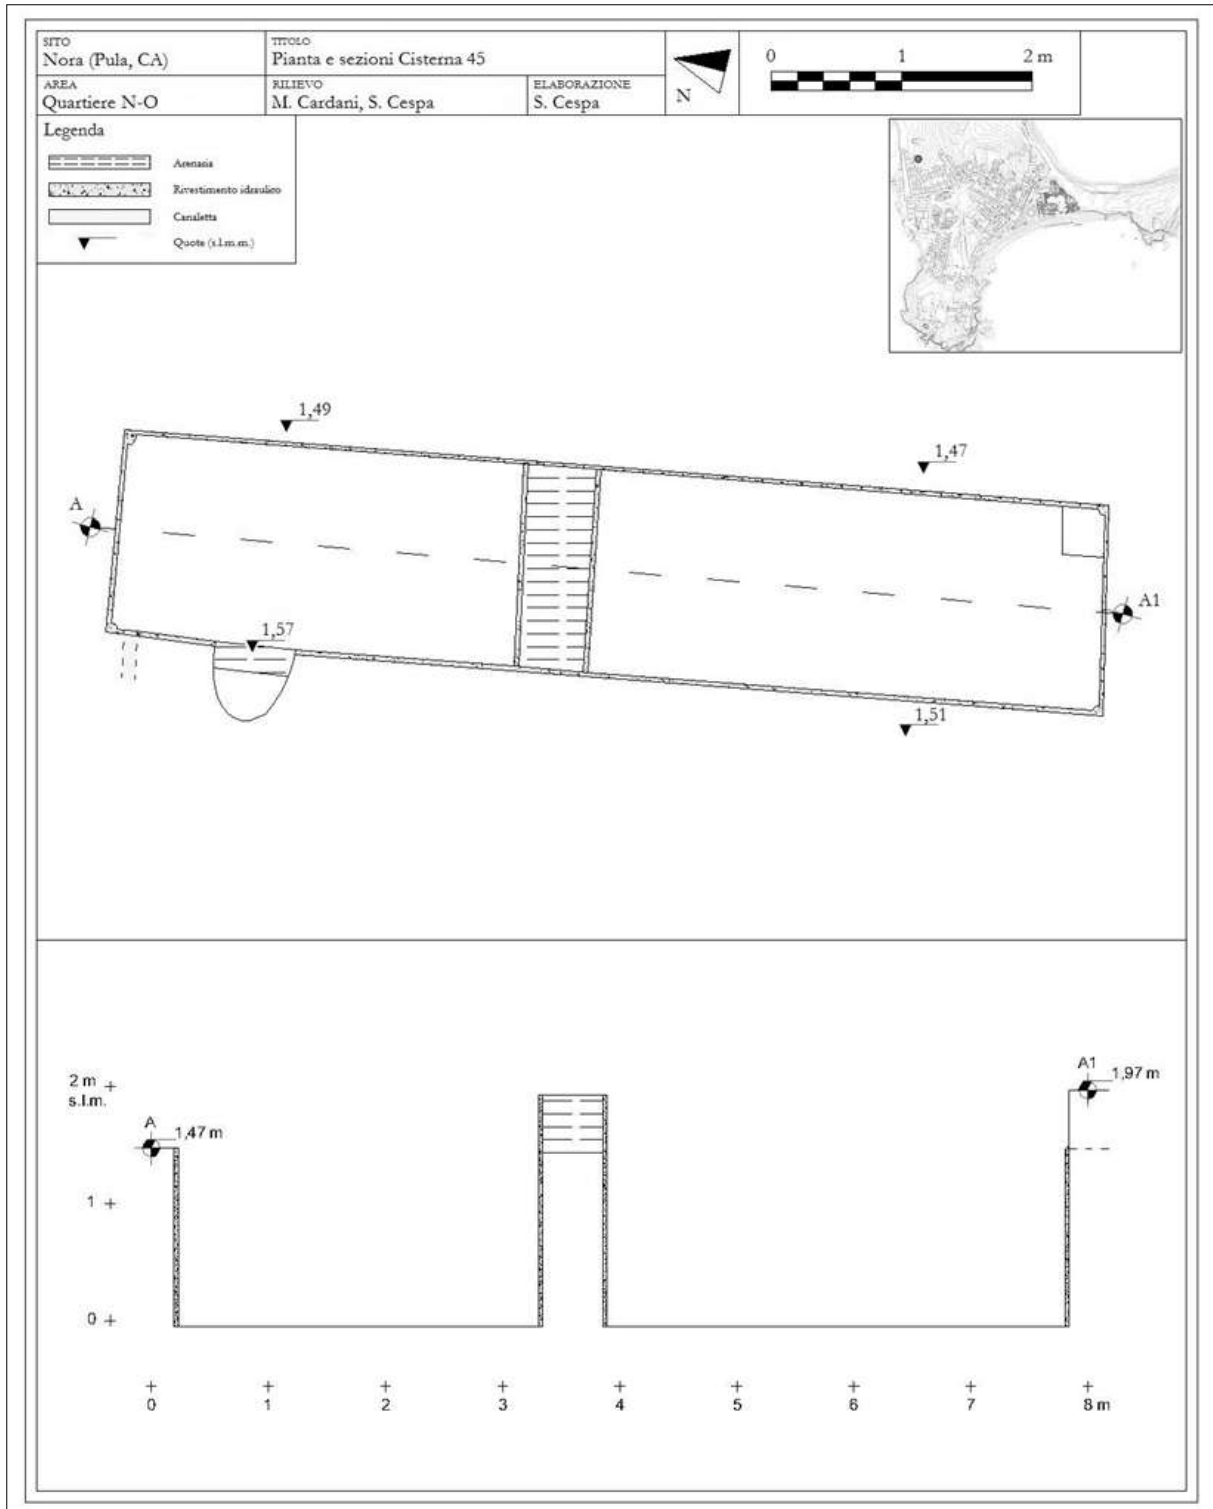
Pianta e sezione della cisterna 45 (elaborazione dell'autore).
